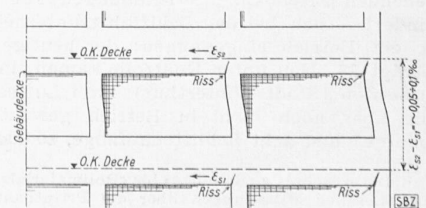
Risse in Fassadenstürzen, von den Ecken ausgehend
